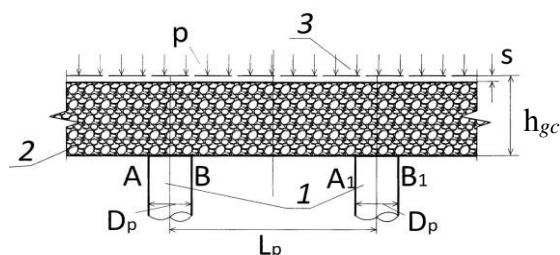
Сечение вертикальной плоскостью свайного фундамента с ПРС:
